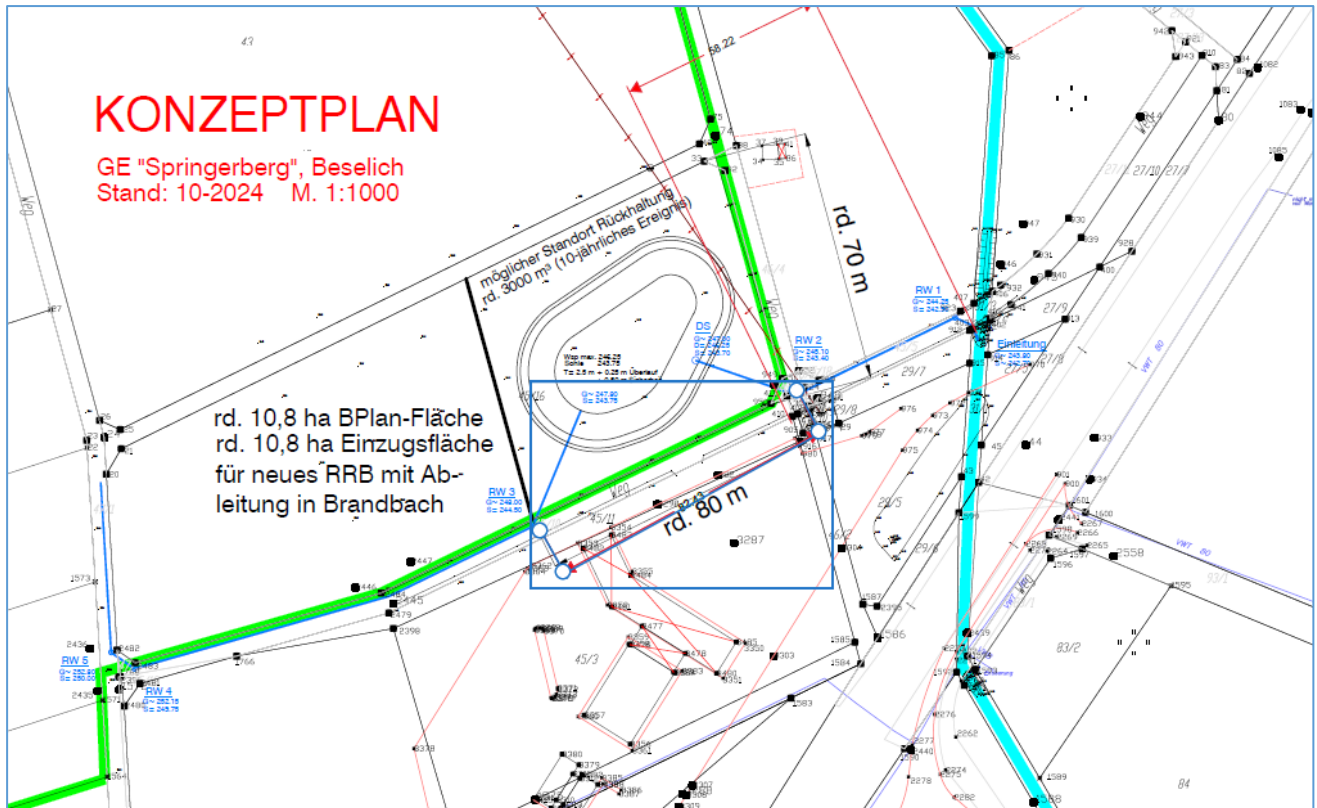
Konzeptplan 2024-10-01 _Neubau RRB mit Ableitung in Brandbach [6]
